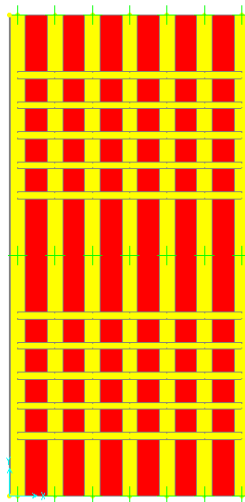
50 Sección del tablero 1x2 m plano x-y
